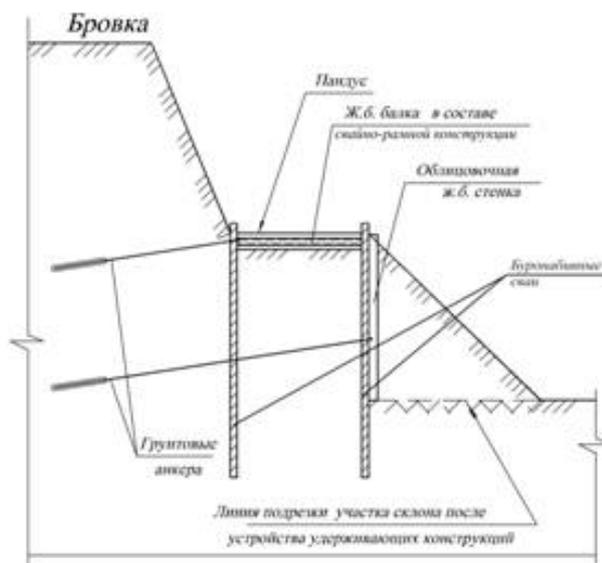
Схема расположения свайно-рамной заанкеренной конструкции удерживающего сооружения
